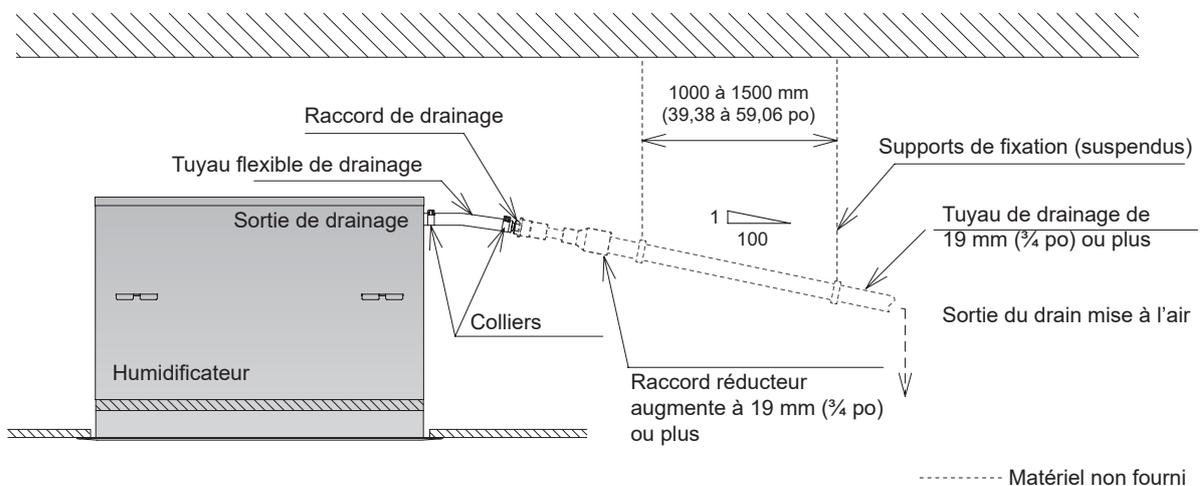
Disposition de la conduite de drainage (générale) – Tuyauterie horizontale
